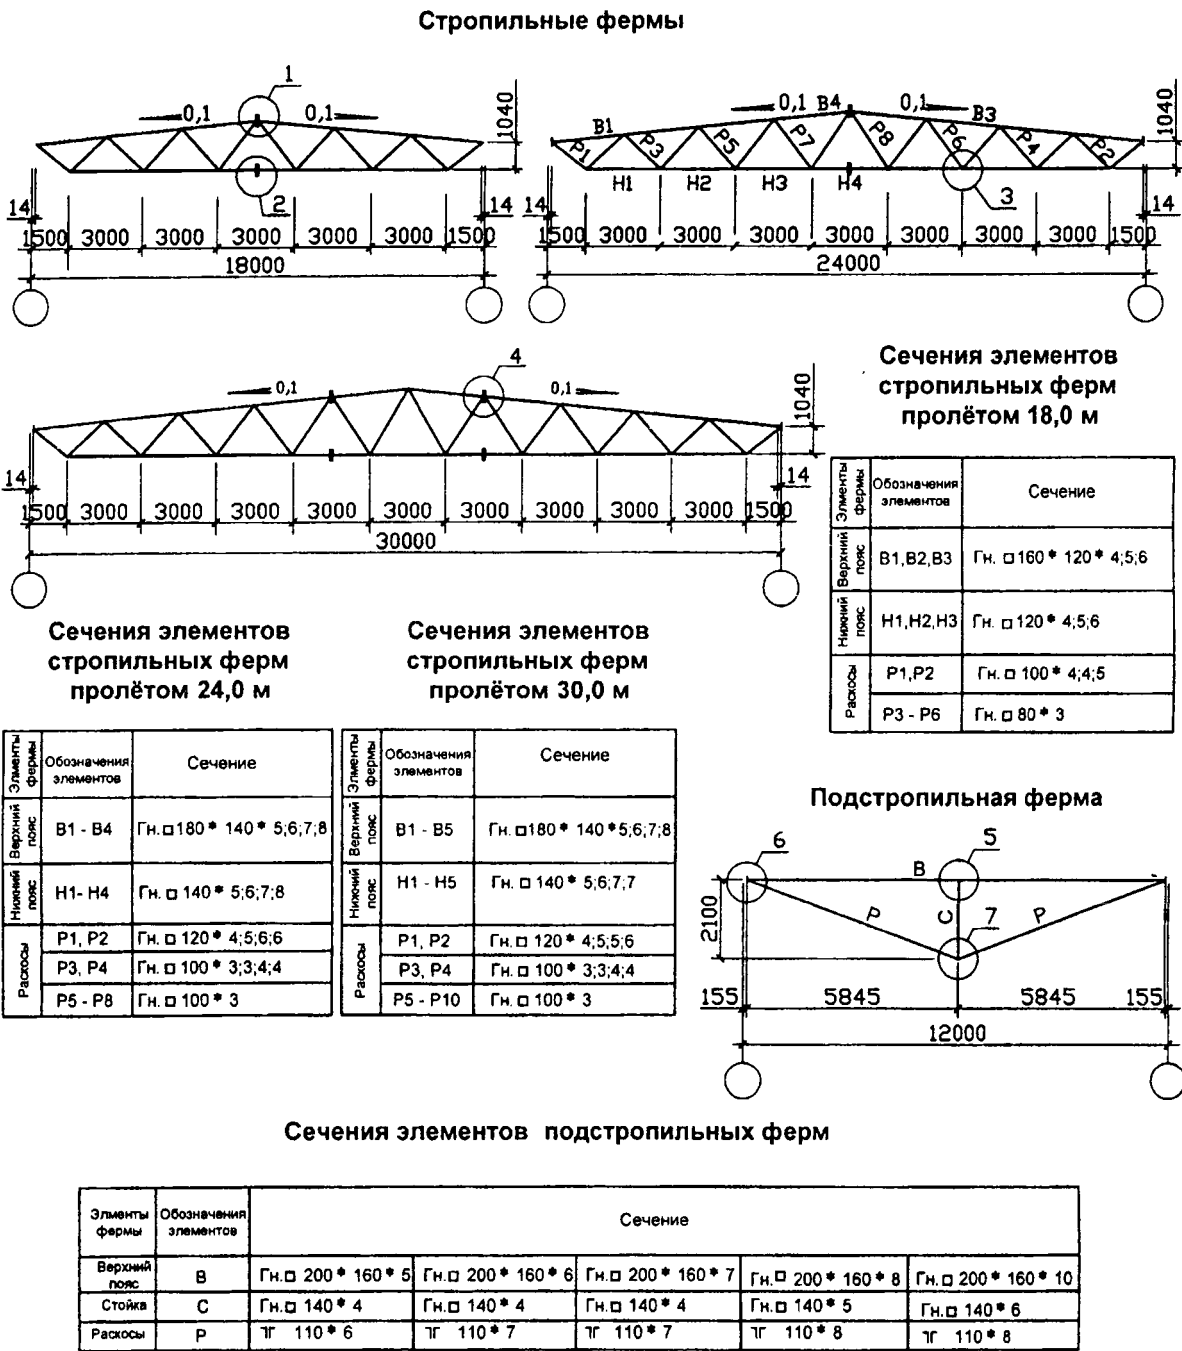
Геометрические схемы несущих конструкций покрытий из замкнутых гнутосварных профилей с уклоном кровли 10 % (серия 1.460.3-23.98)
